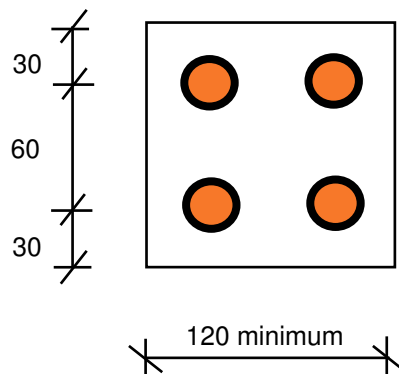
Géométrie de la section de l'éprouvette en chêne
